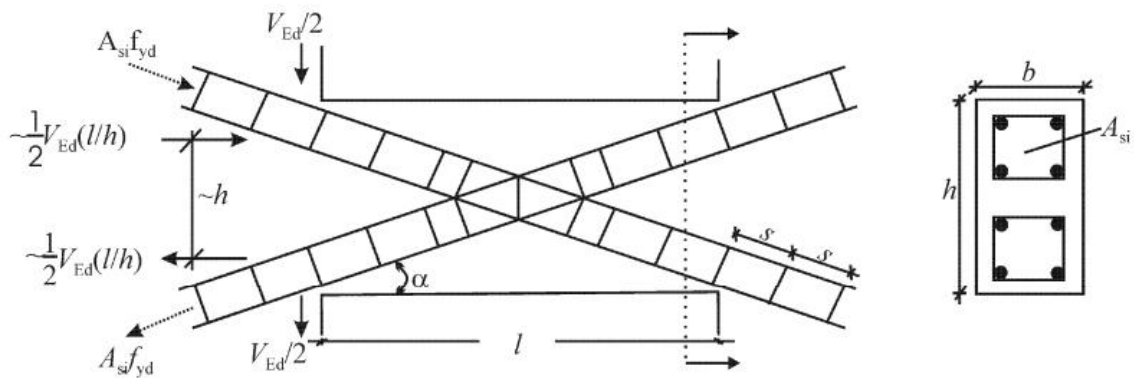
Vigas de acoplamento com armaduras diagonais [5]
